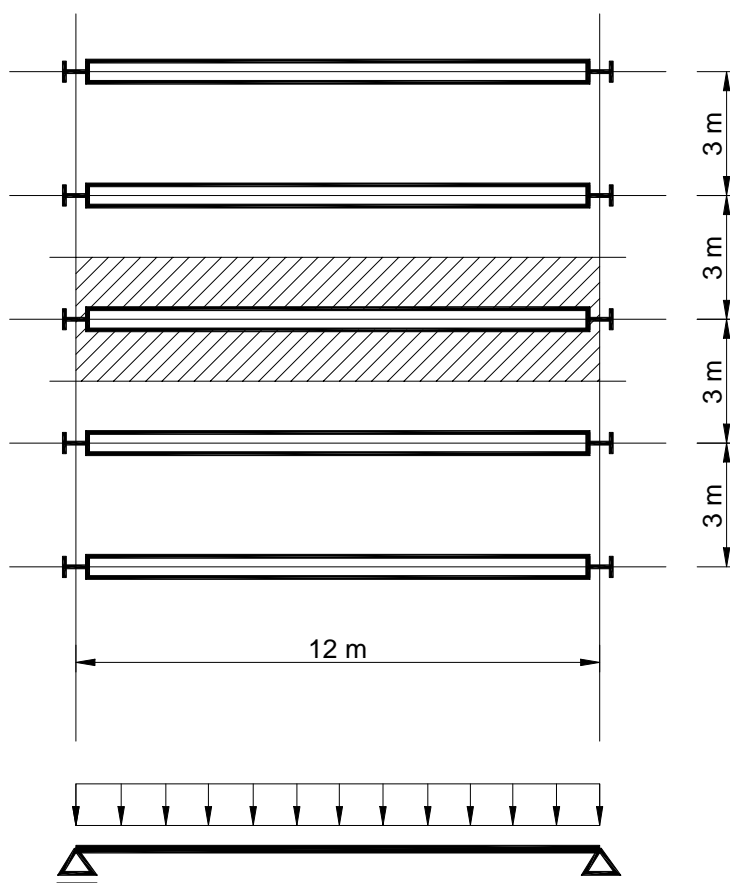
Pianta del solaio con travi in acciaio composte semplicemente appoggiate
